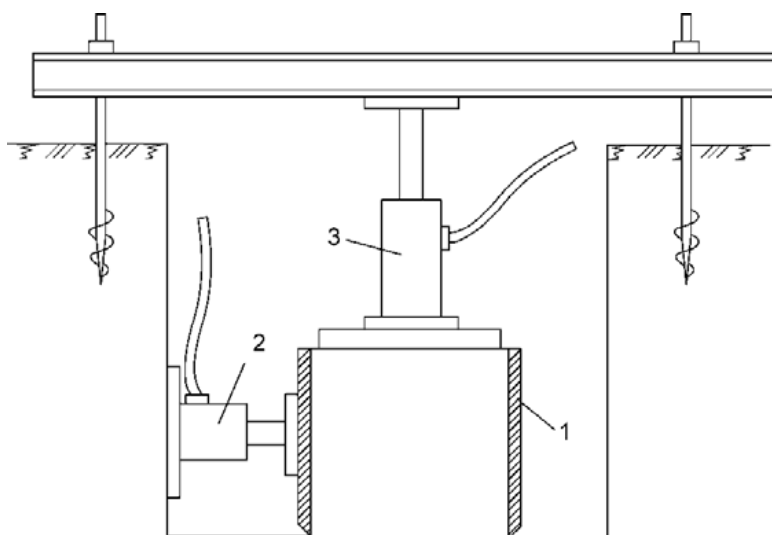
Испытания блока грунта на сдвиг: 1 — стальной цилиндр; 2 — домкрат горизонтальной нагрузки; 3 — домкрат вертикальной нагрузки
